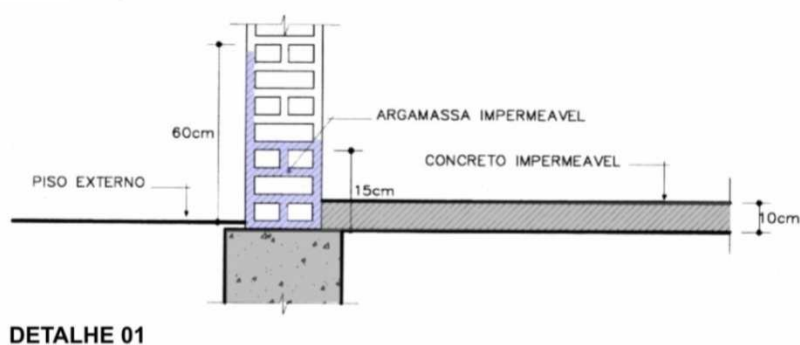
Detalhe 1 - Impermeabilização no Embasamento.
